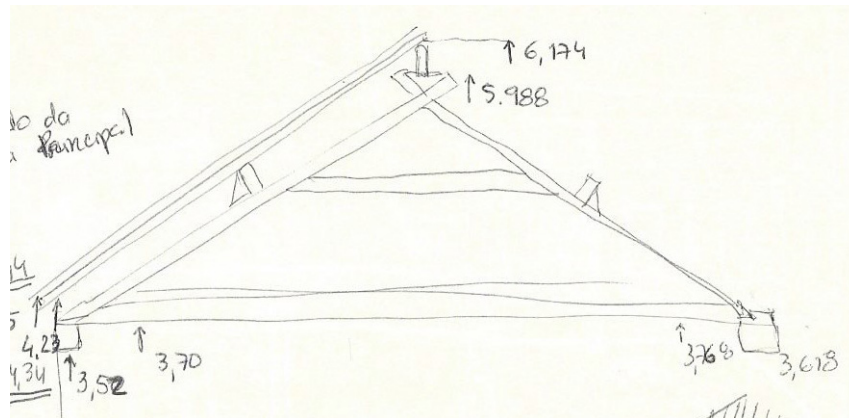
| Desenhos de levantamento da asna da adega; pormenor de encontro da perna com a linha
